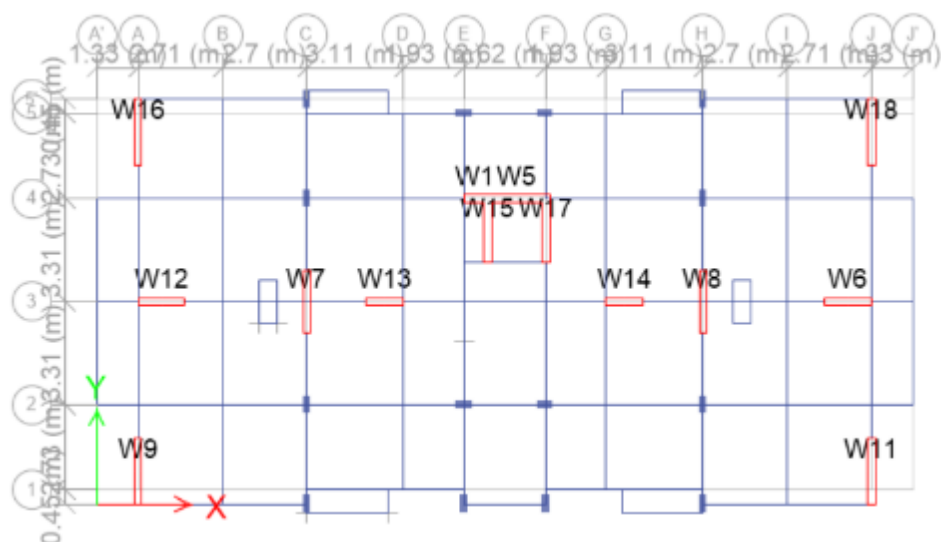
Plano de Planta – Estructura (Deriva máx = 0.010)
